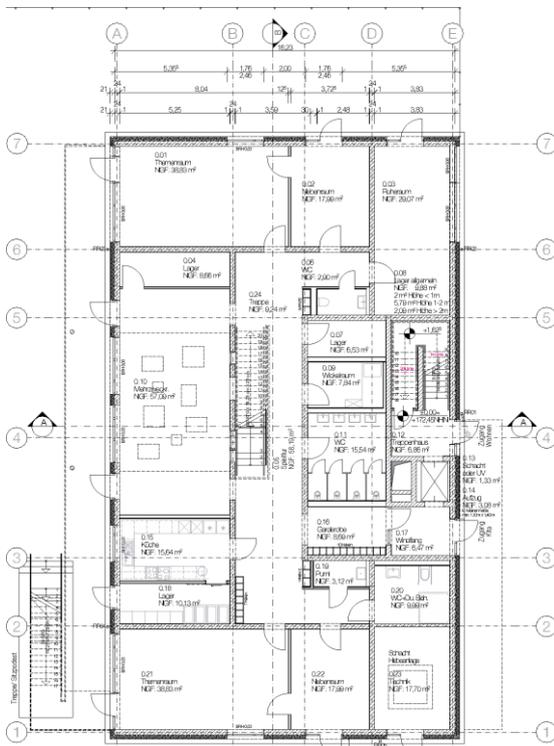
Grundriss EG _ Kita_HWR
